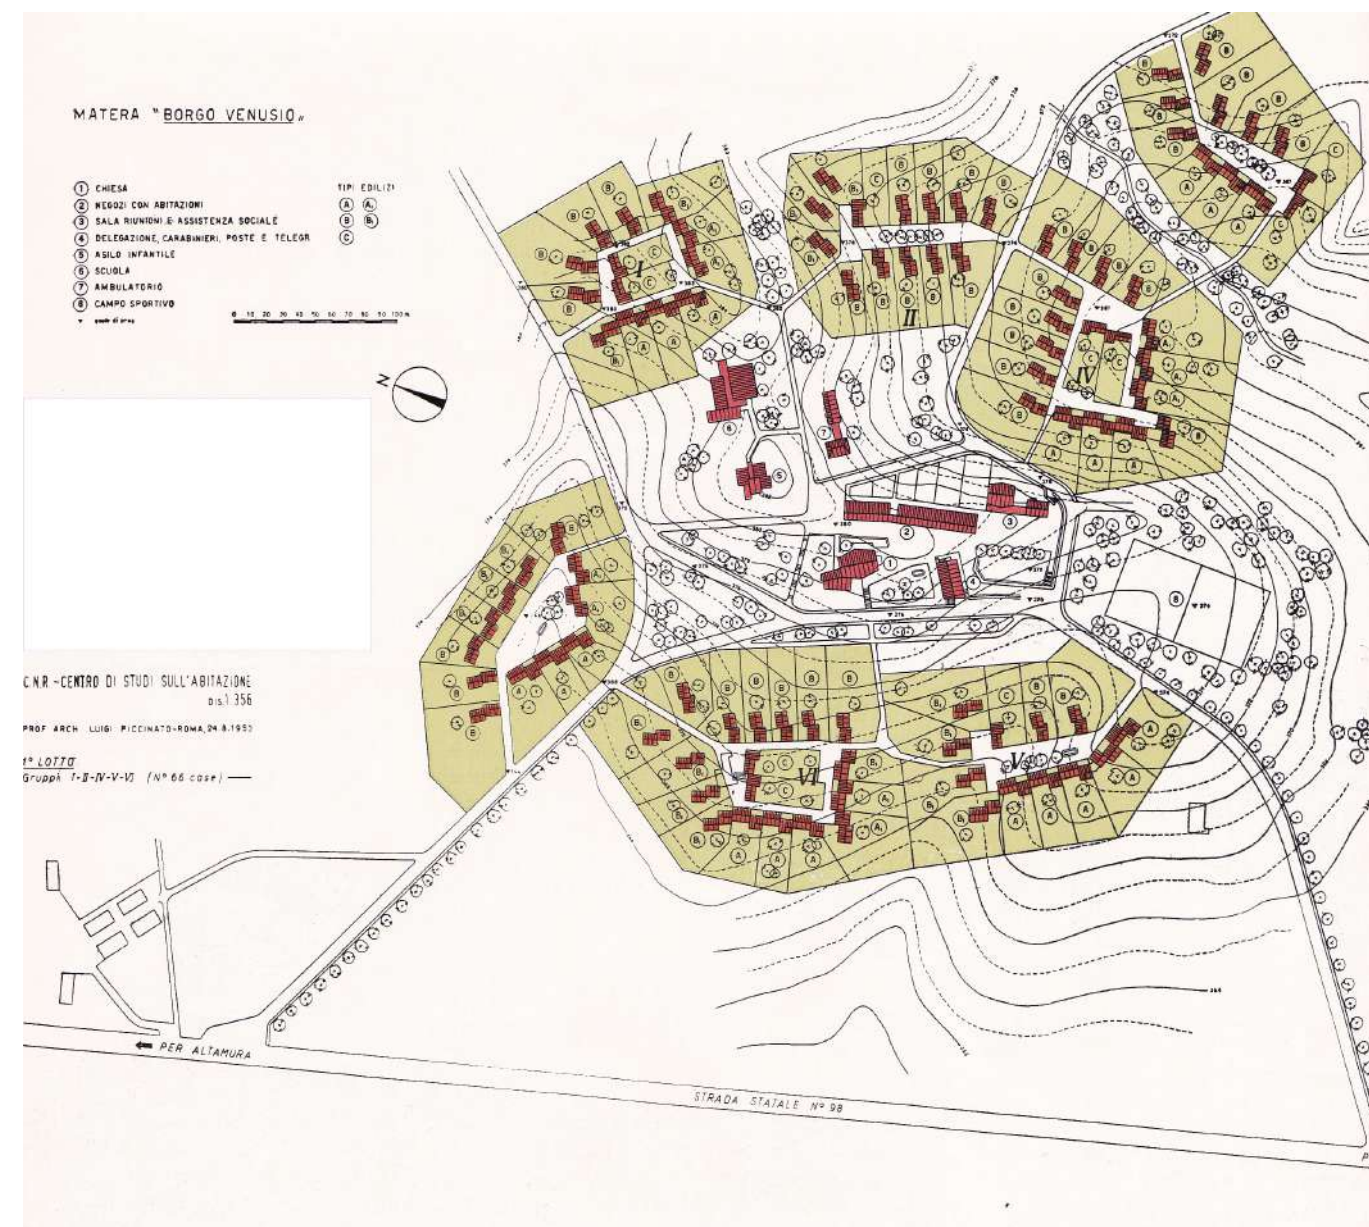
Planimetria del progetto originario di borgo Venusio. Luigi Piccinato
